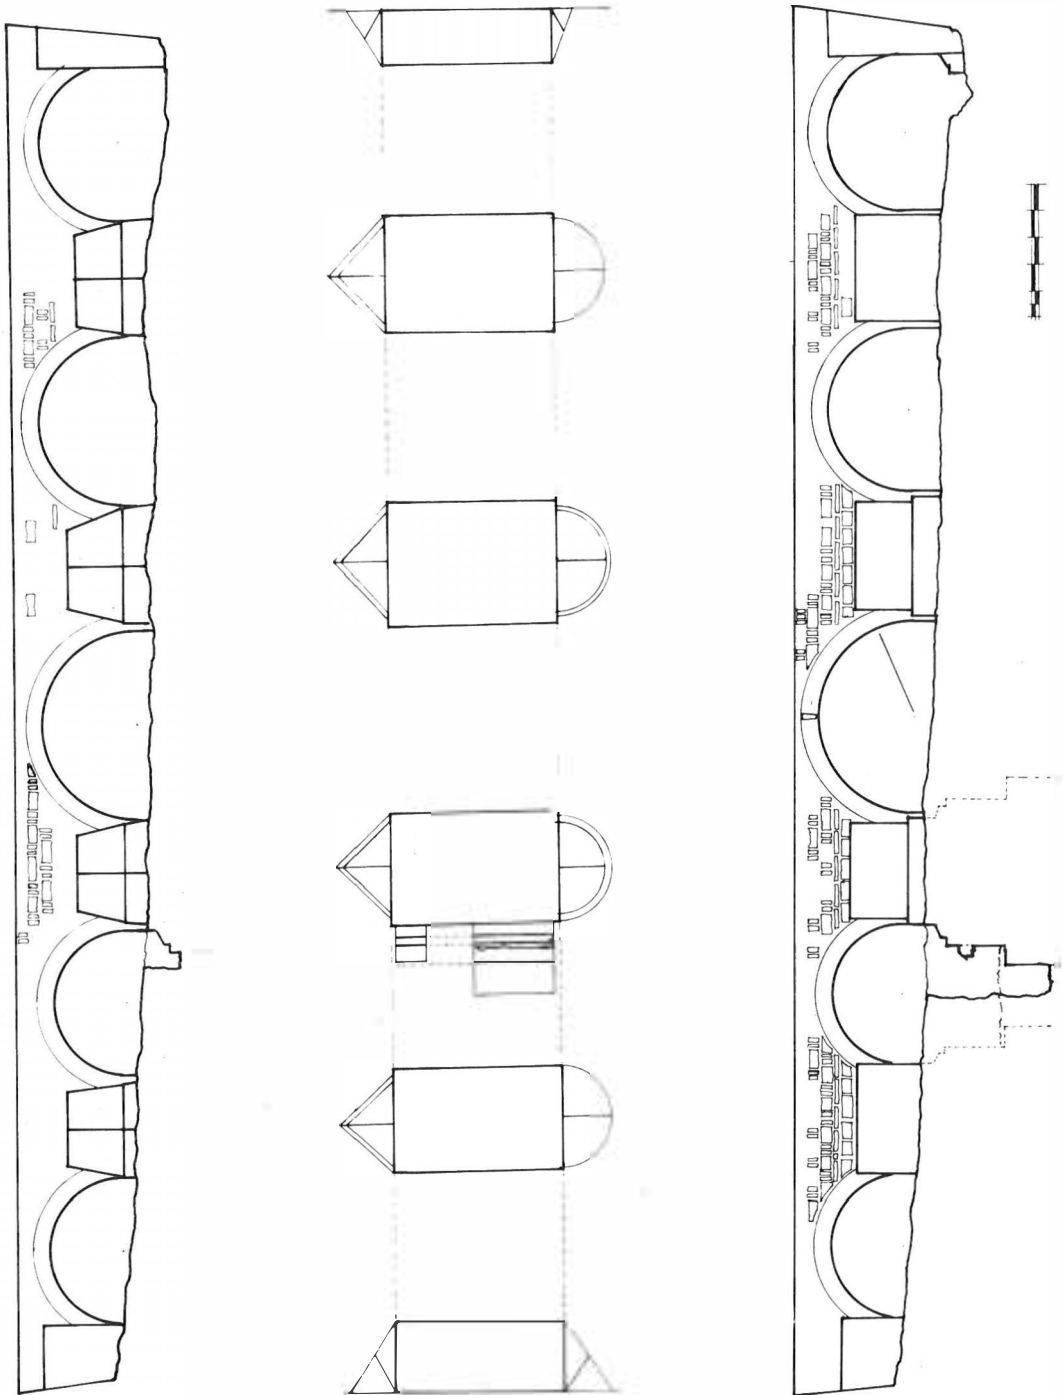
Alzados y planta del puente del Genil tras la reforma de 1986. (Dibujo C. Vilchez).
